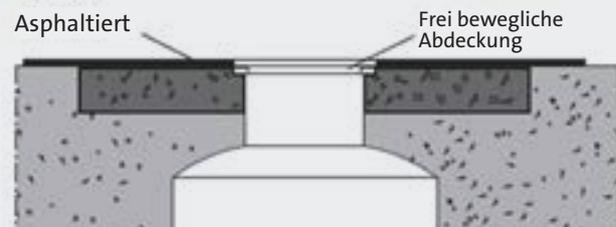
Pumpstation mit Asphaltierung sowie mit Betonring und verkehrsgerechter Abdeckung
